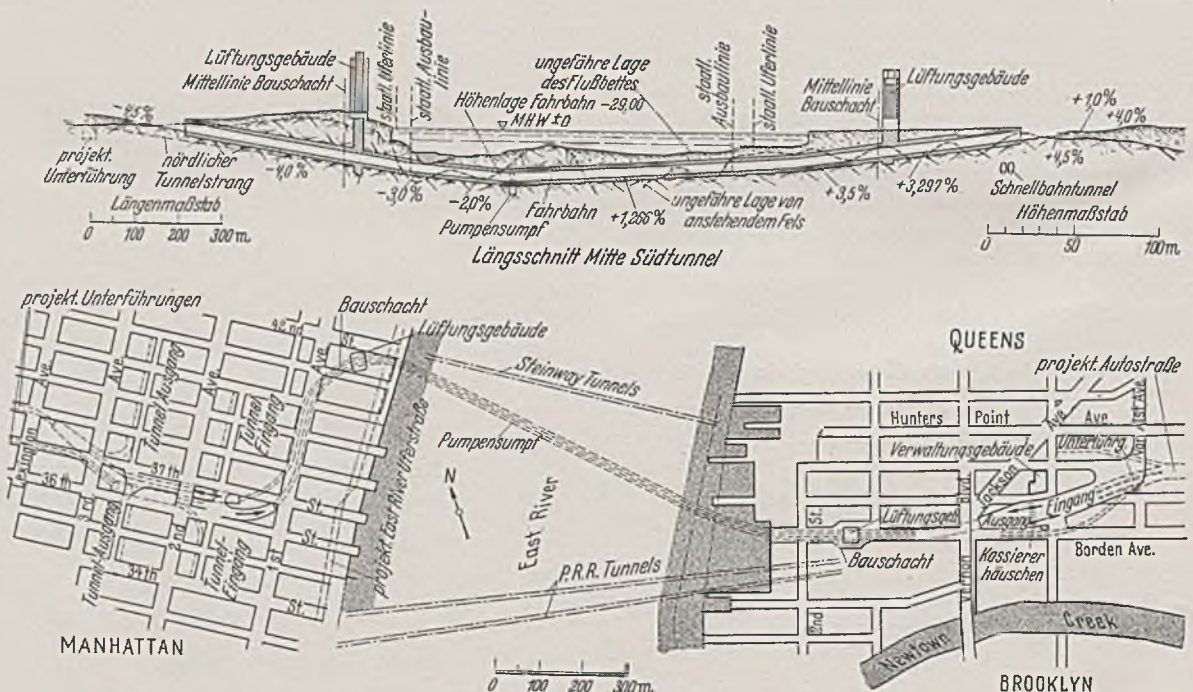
Lageplan und Längsschnitt des Tunnels.
